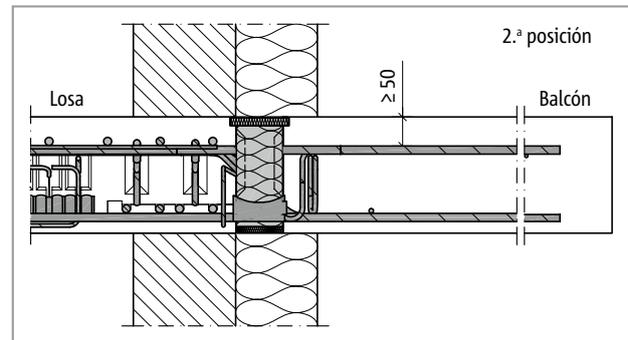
Schöck Isokorb® T tipo C: Sección 2.ª posición; conexión para sistema de aislamiento térmico exterior (SATE)
